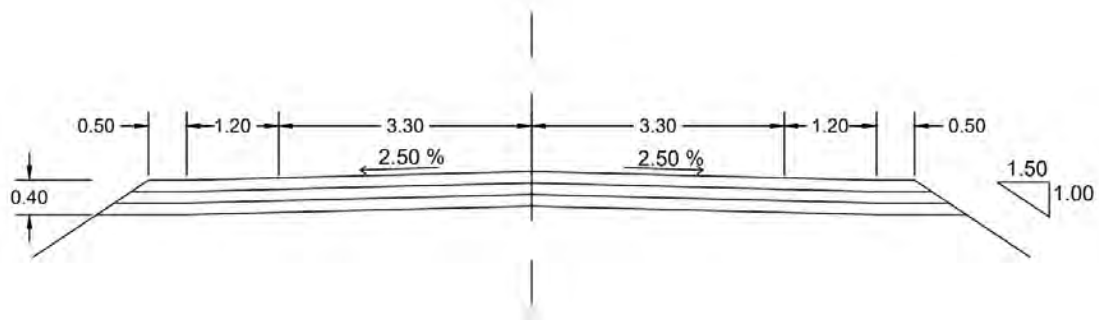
Detalle del diseño geométrico del pavimento flexible para 10 años
